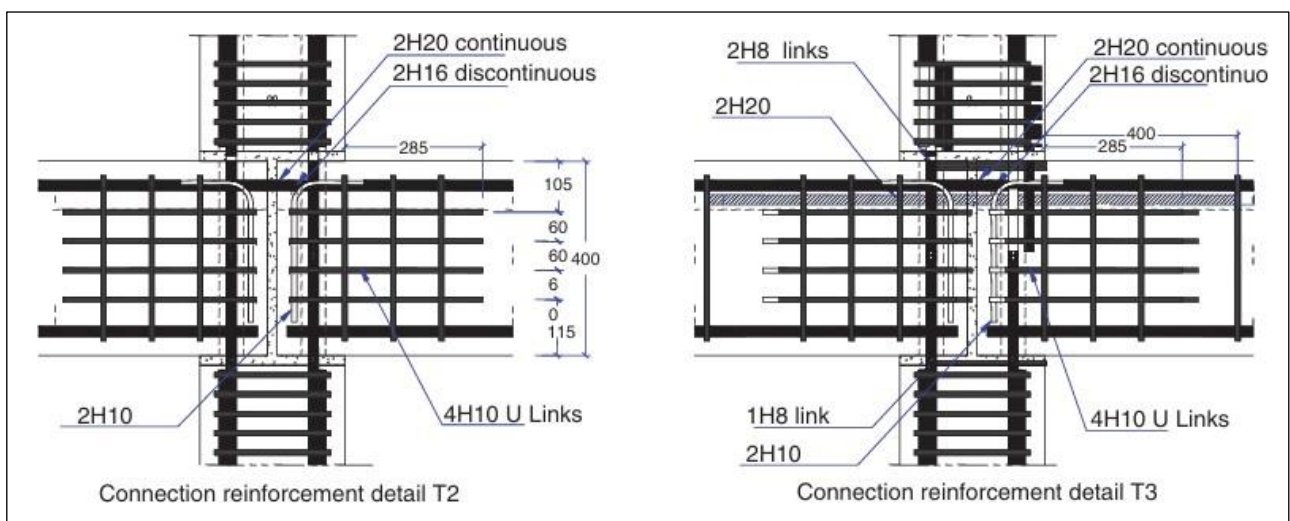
Détails importants du ferrailage aux extrémités des poutres nécessaires pour assurer un comportement satisfaisant de l'assemblage poutre-poteau [36].
